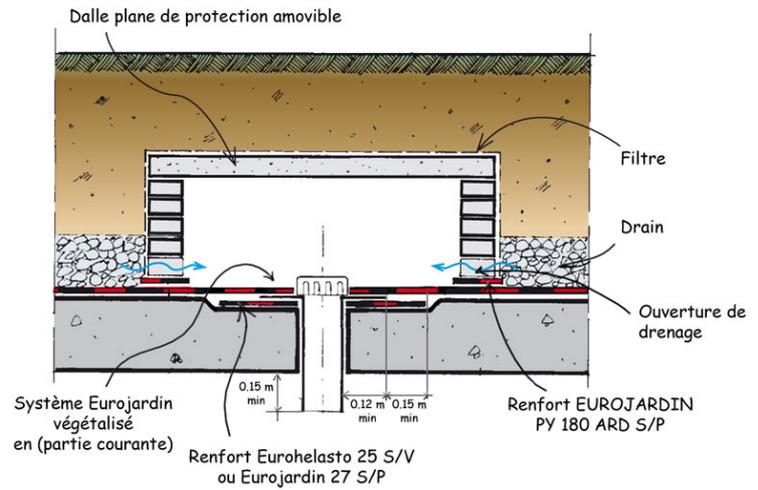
Entrée d'eaux pluviales toitures-terrasses jardins
